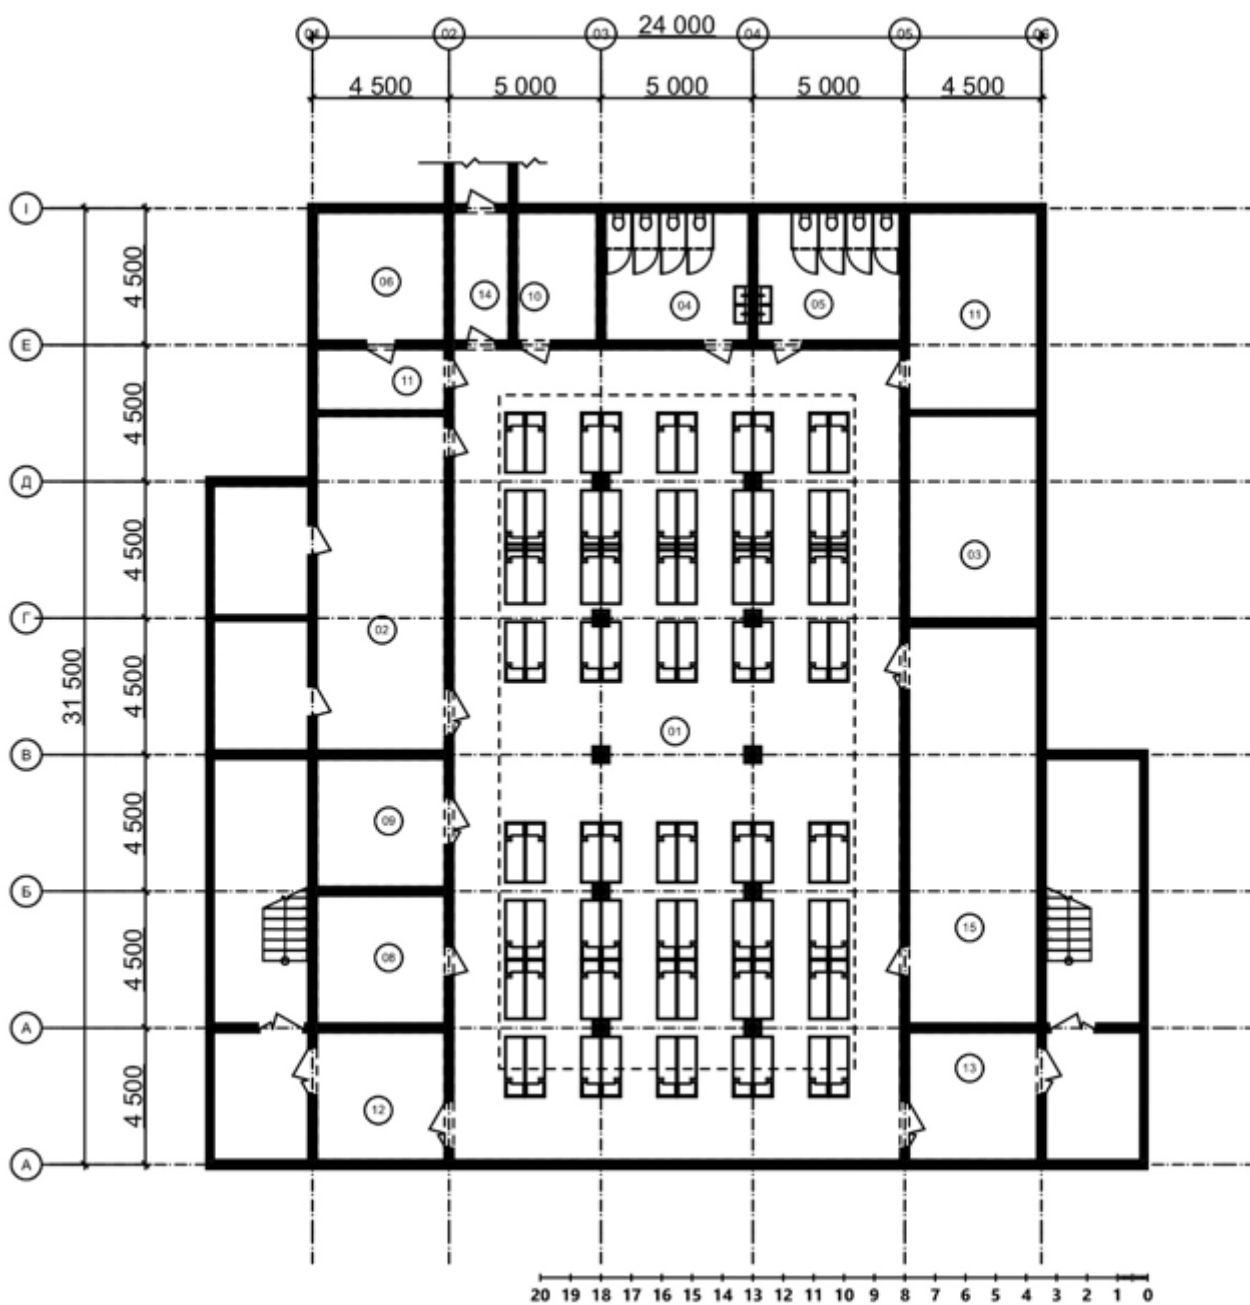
Креслення плану сховища ЦЗ на 500 чол.
